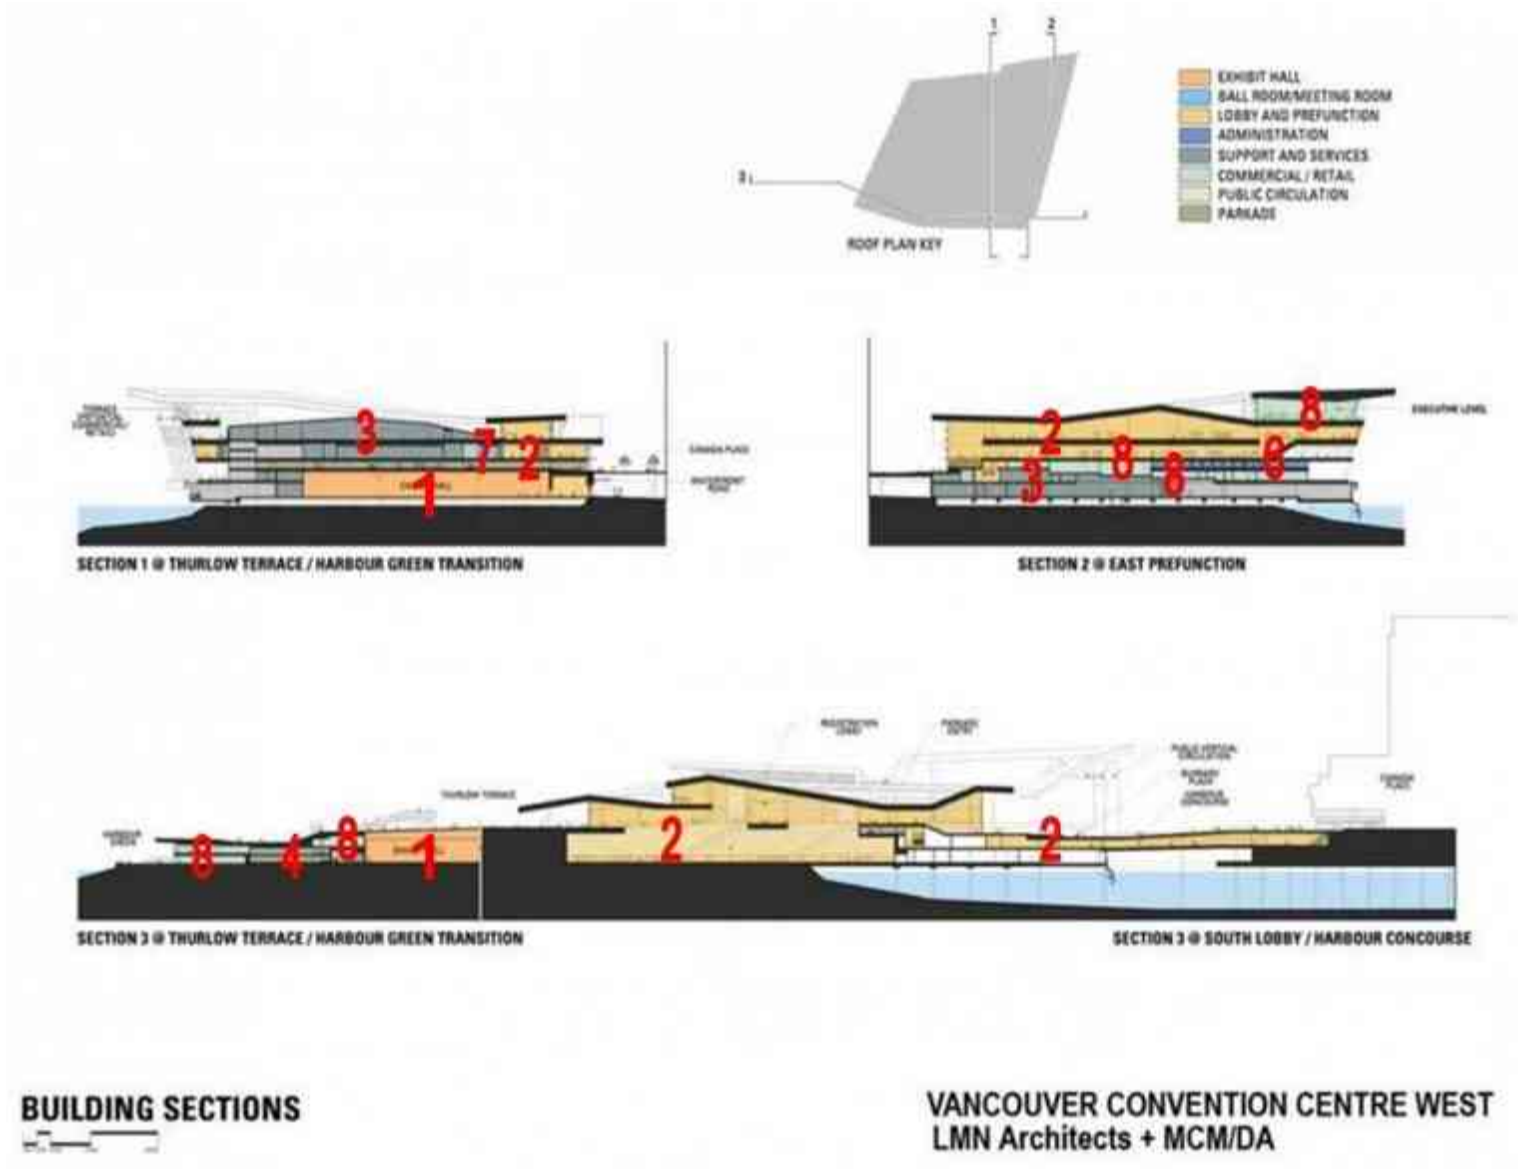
Programa Arquitectónico. Foto LMN / Studio. (<http://www.archdaily.com/130373>). 14 oct. 2012
